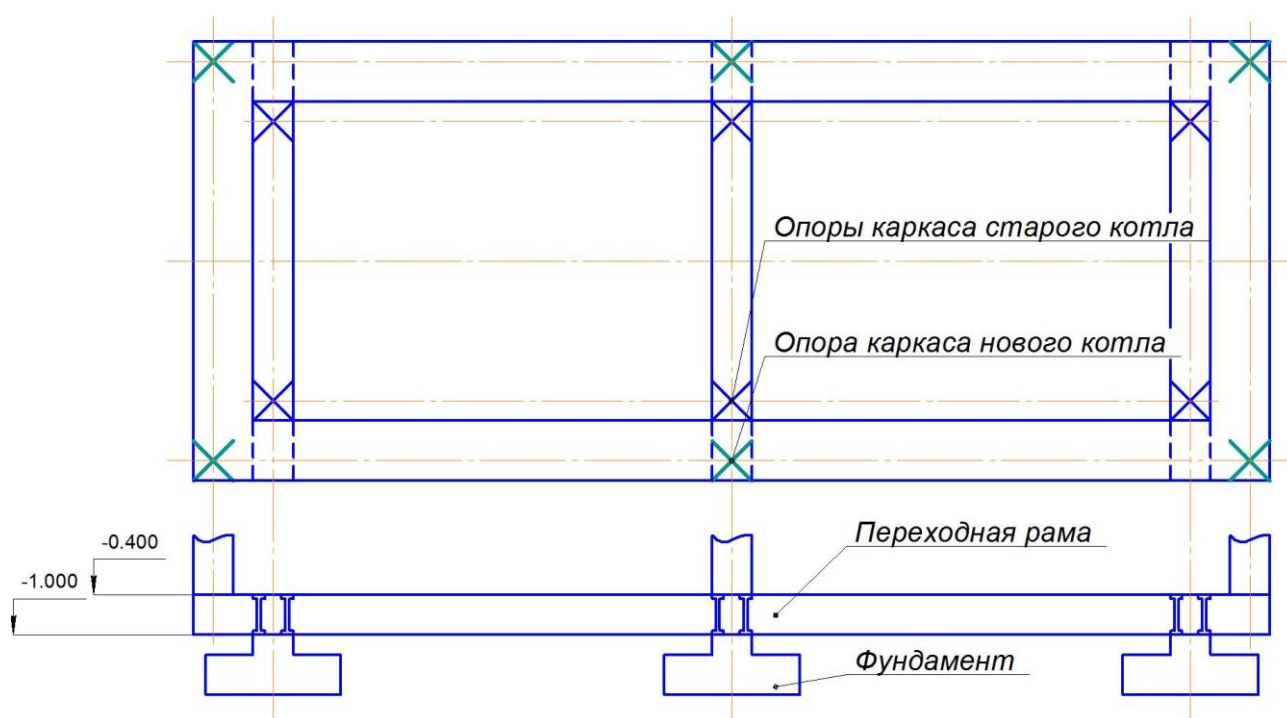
Схема переходной рамы каркаса котла при установке на старый фундамент
